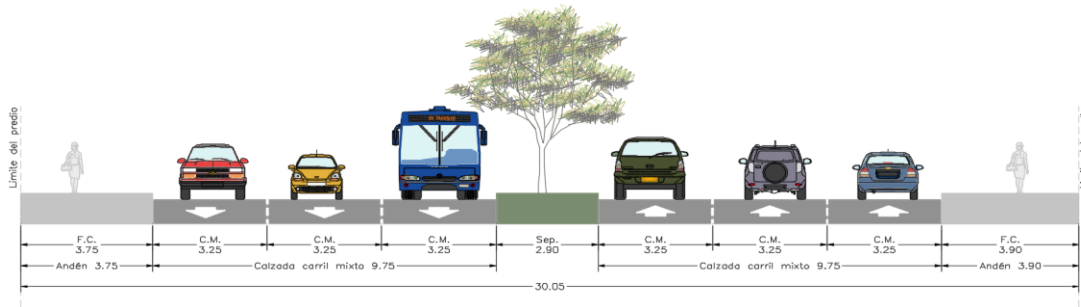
Sección Típica sobre la Calle 1 entre KR 27 y Av. Caracas
